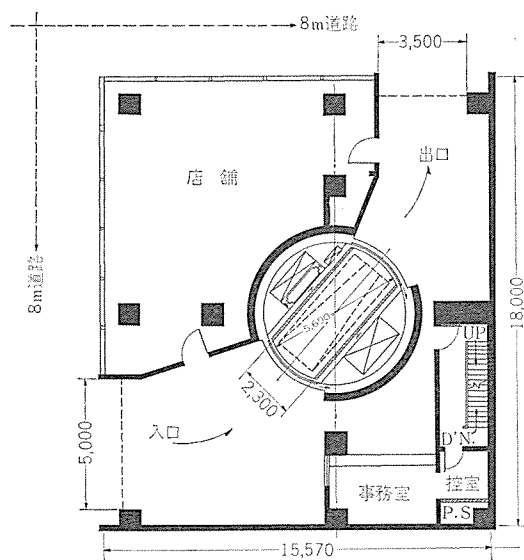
中川ビル駐車場1階平面図(旋回エレベータ式)
